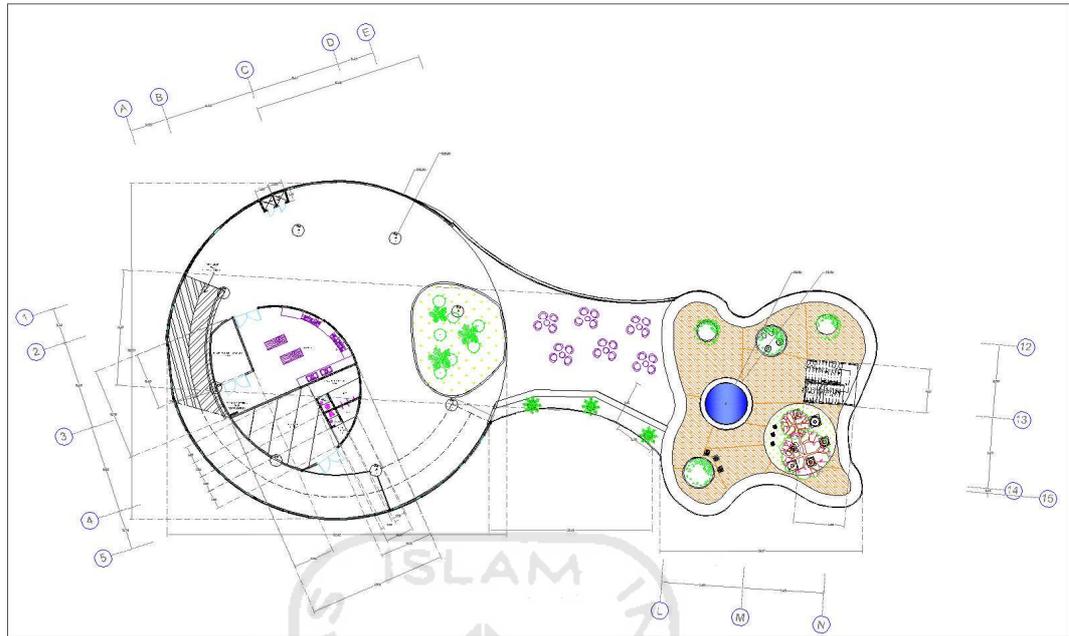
Denah Lantai 2 Bangunan Utama
